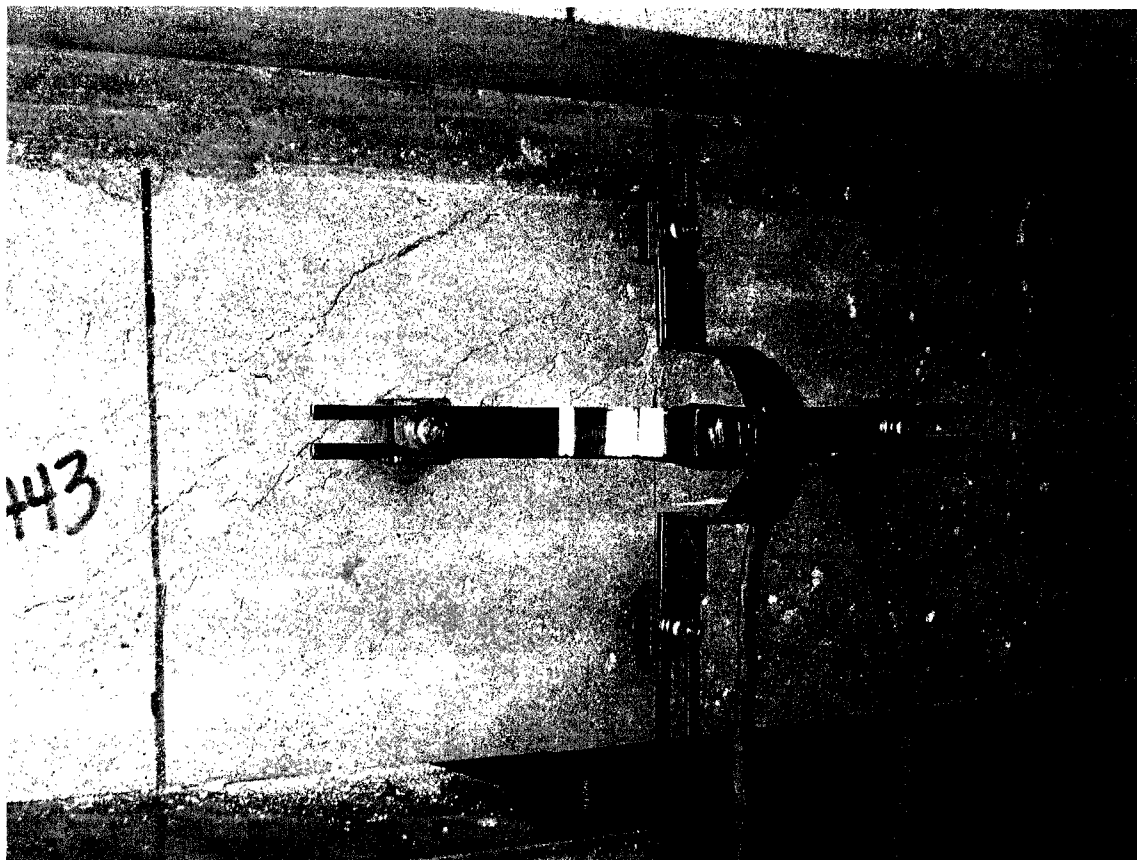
Capteurs de fissures dans les sens horizontal et vertical
